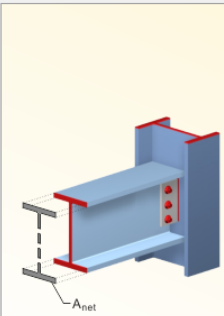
Querschnittsfläche für Zugnachweis definieren
